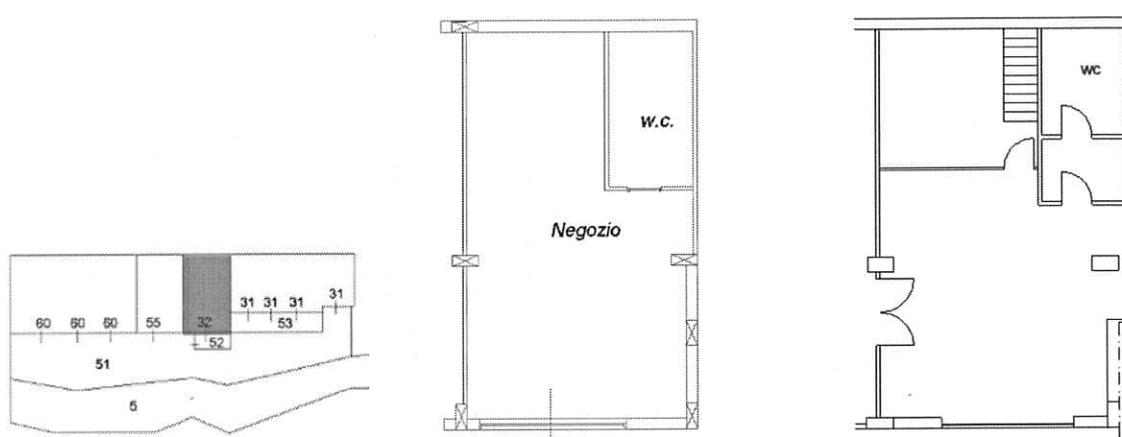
Planimetria catastale del locale sub 32 e rilievo stato di fatto.
